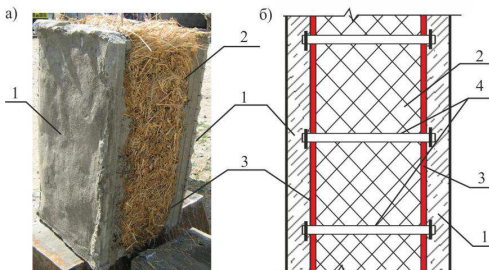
Новая конструкция многослойной стены: а – экспериментальный образец; б – поперечный разрез МС: 1–армированный торкрет-бетон, 2 – органический утеплителя; 3 – контактный слой, 4 – связи
